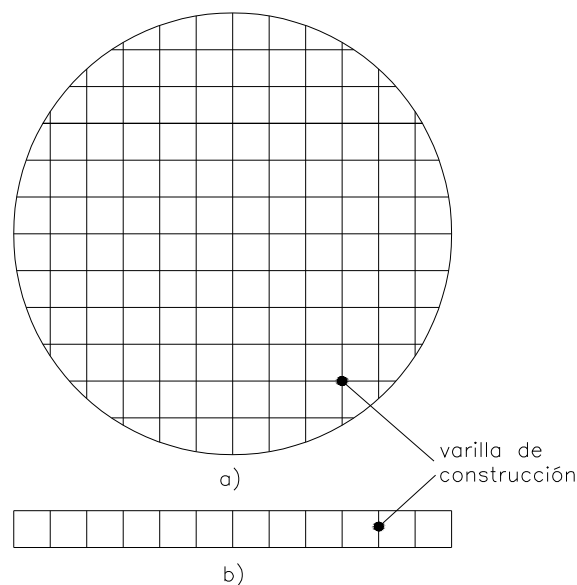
Estructura soporte a) vista superior, b) vista lateral.
